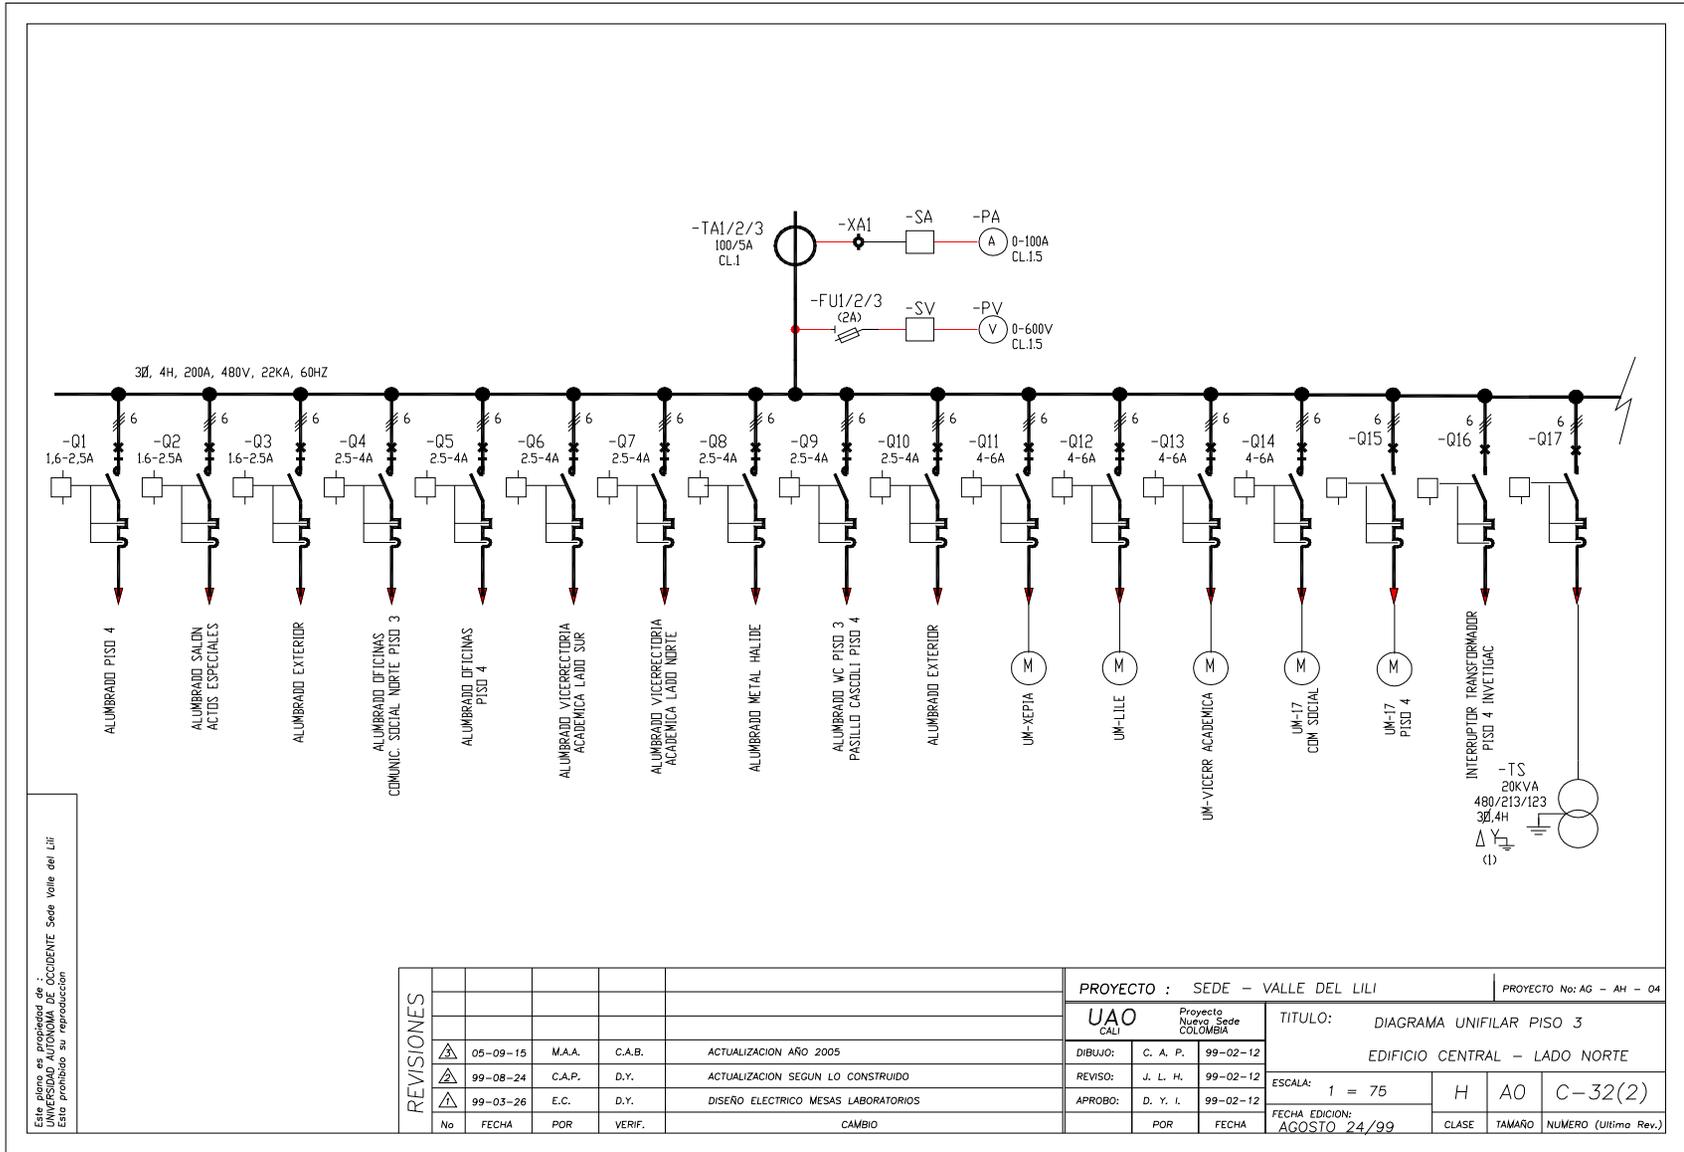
Tablero de Distribución, tablero auxiliar y transformador Ed. Central piso3 lado norte
